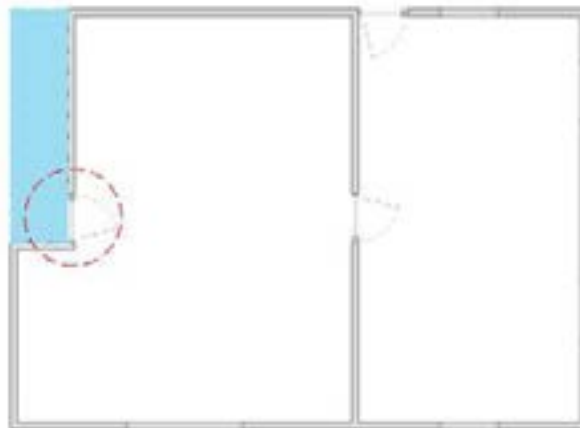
Planta esquema circulaciones Bloque No.13.
